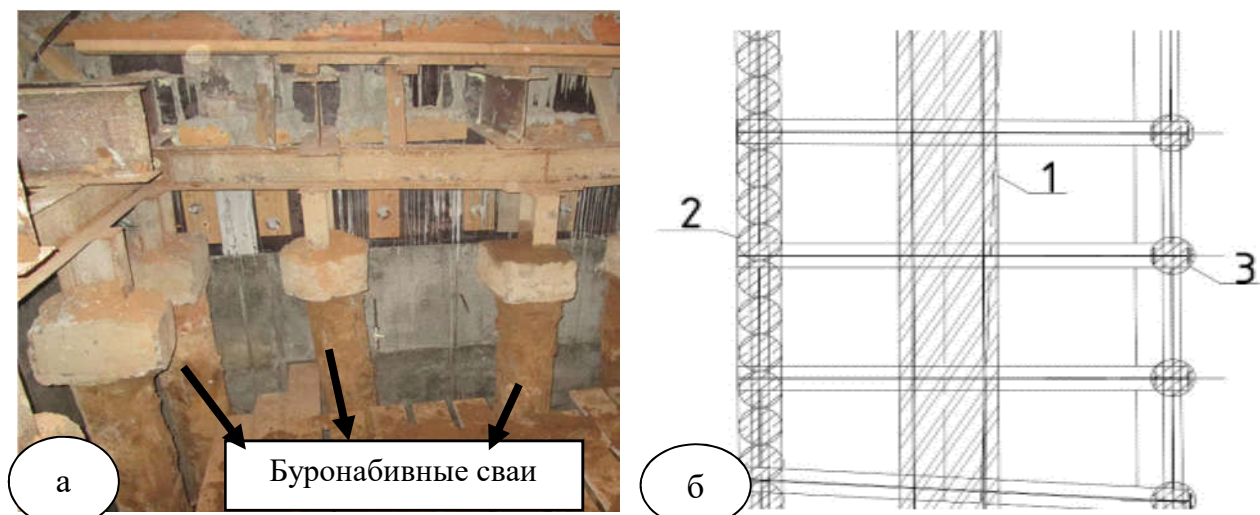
а) устройство буронабивных свай; б) расположение свай: 1- внешняя стена; 2- внешний ряд буронабивных свай; 3-внутренний ряд буронабивных свай
